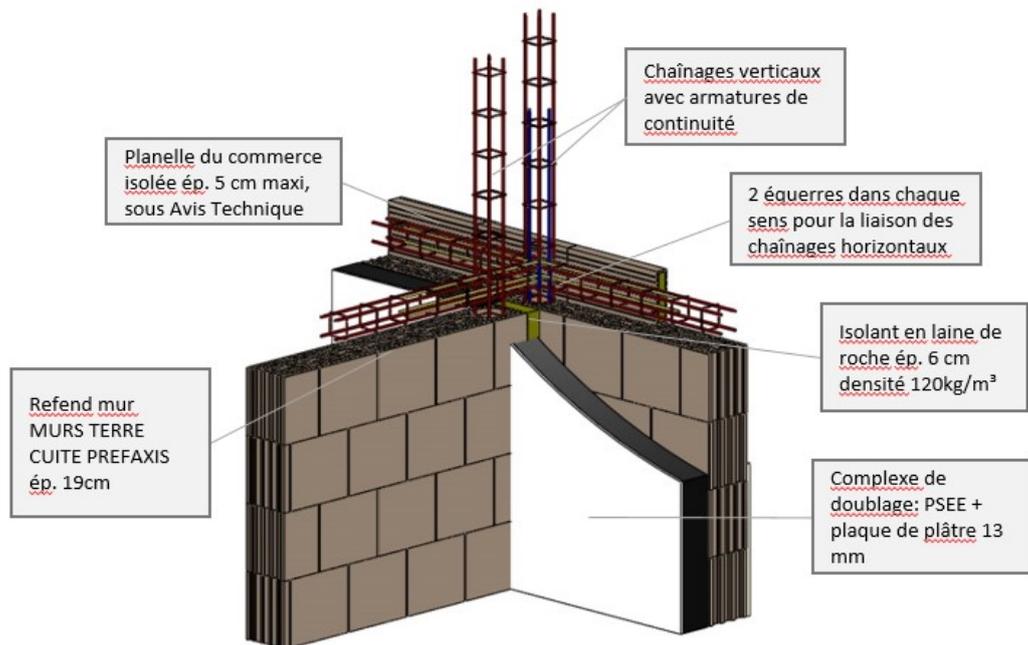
Détail jonction refend BA façade par juxtaposition d'isolant intercalé (locaux chauffés, ITI, hors applications parasismiques)
